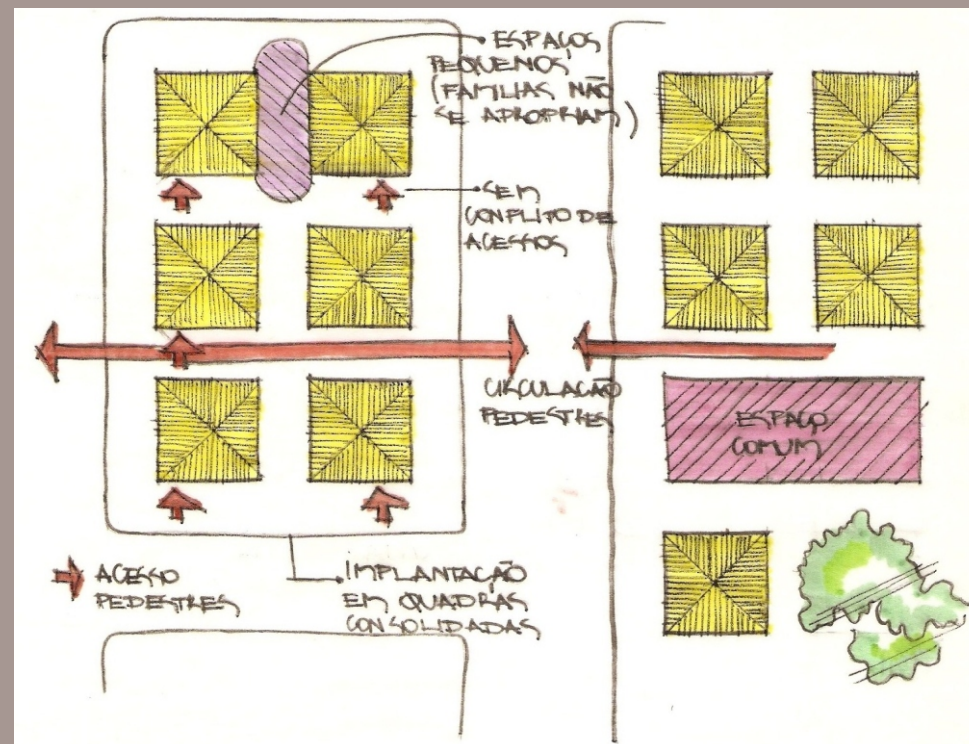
Planta baixa. Análise Assentamento Provisório de papelão.
